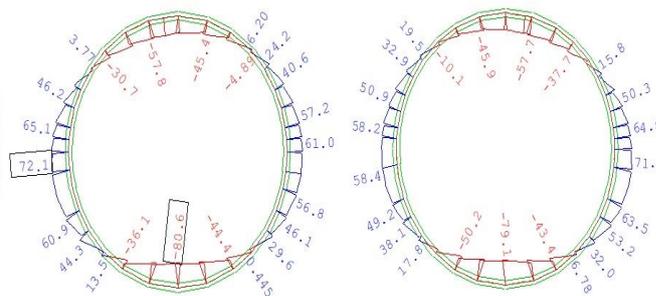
Эпюра моментов, возникающая в конструкции железобетонной обделки на стадии завершения строительства тоннеля в разрезе
